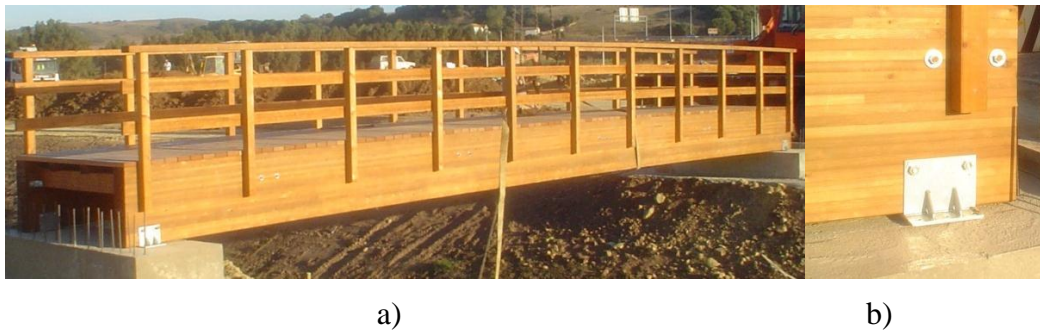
a) Vista de un puente peatonal; b) detalle del apoyo tipo A.
